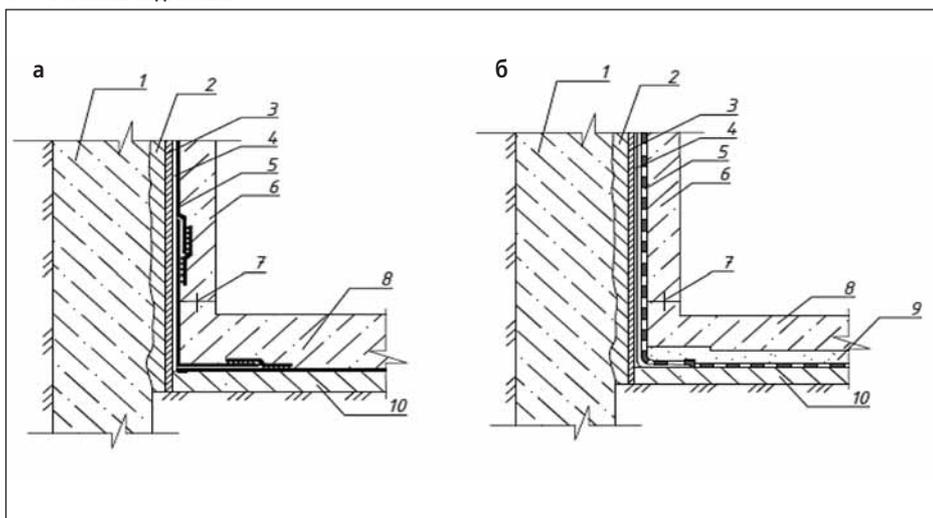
Гидроизоляция несущей «стены в грунте»: 1 – несущая «стена в грунте»; 2 – выравнивающий слой из мелкозернистого бетона; 3 – гидроизоляционное покрытие из напыляемых полимерных составов с двухсторонней адгезией; 4 – прижимная стена из монолитного или фибронабрызг-бетона; 5 – стальной анкер; 6 – стальная сетка
